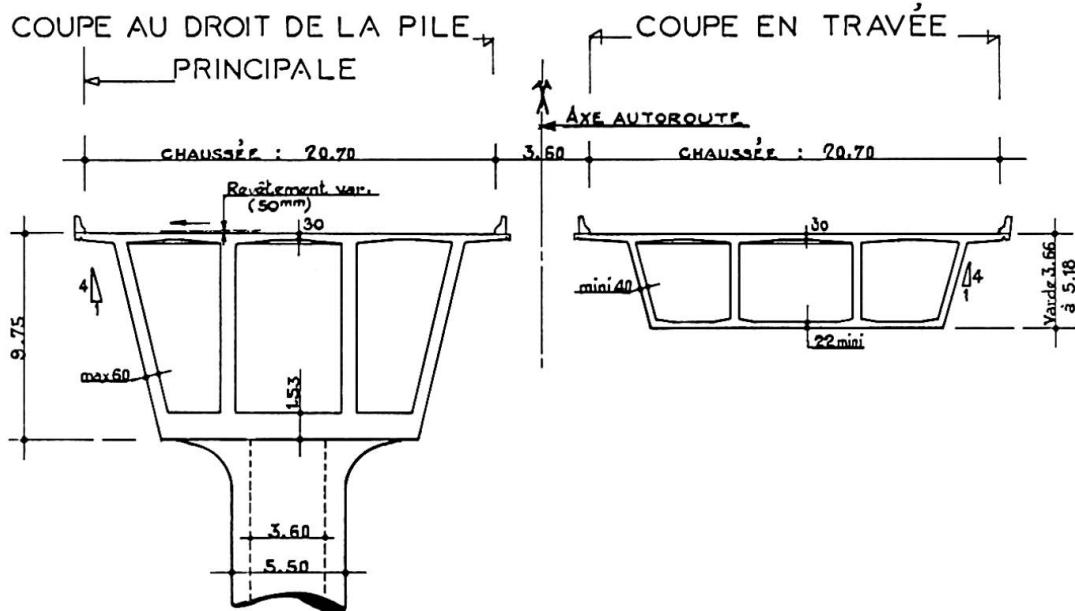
PONT SUR LA RIVIERE COLUMBIA
